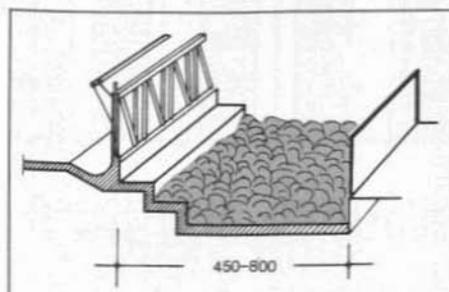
Eingestreute Gruppenbuchten für die Kälberaufzucht: Flachlaufstall (Maße in cm)
